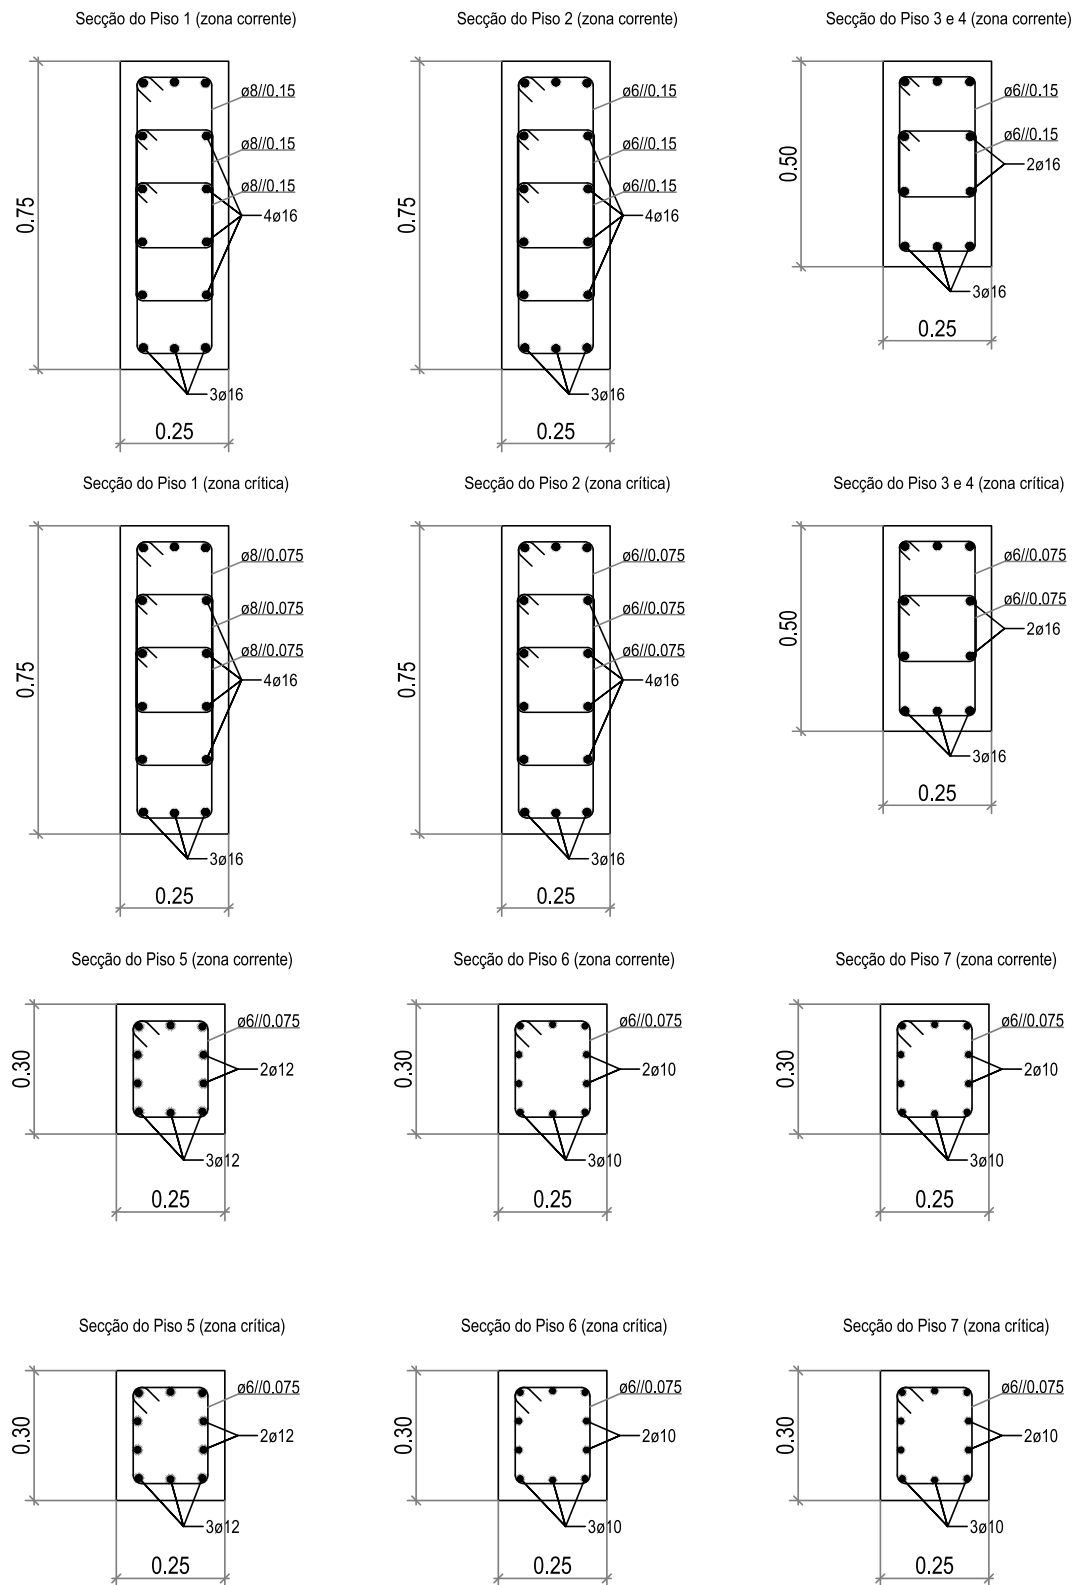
Edifício Modificado: Secções de armadura do pilar central (P3)
